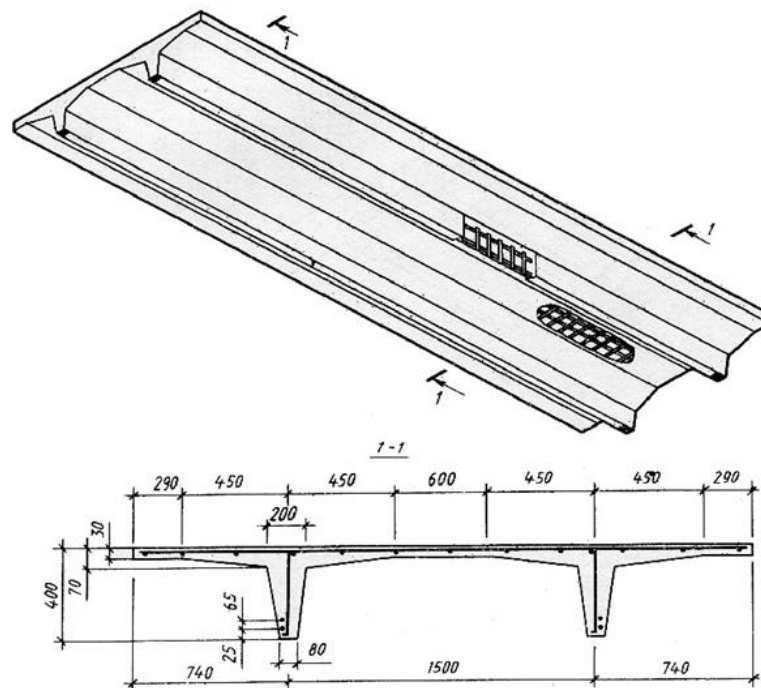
Залізобетнна збірна плита покриття типу «подвійне Т»
